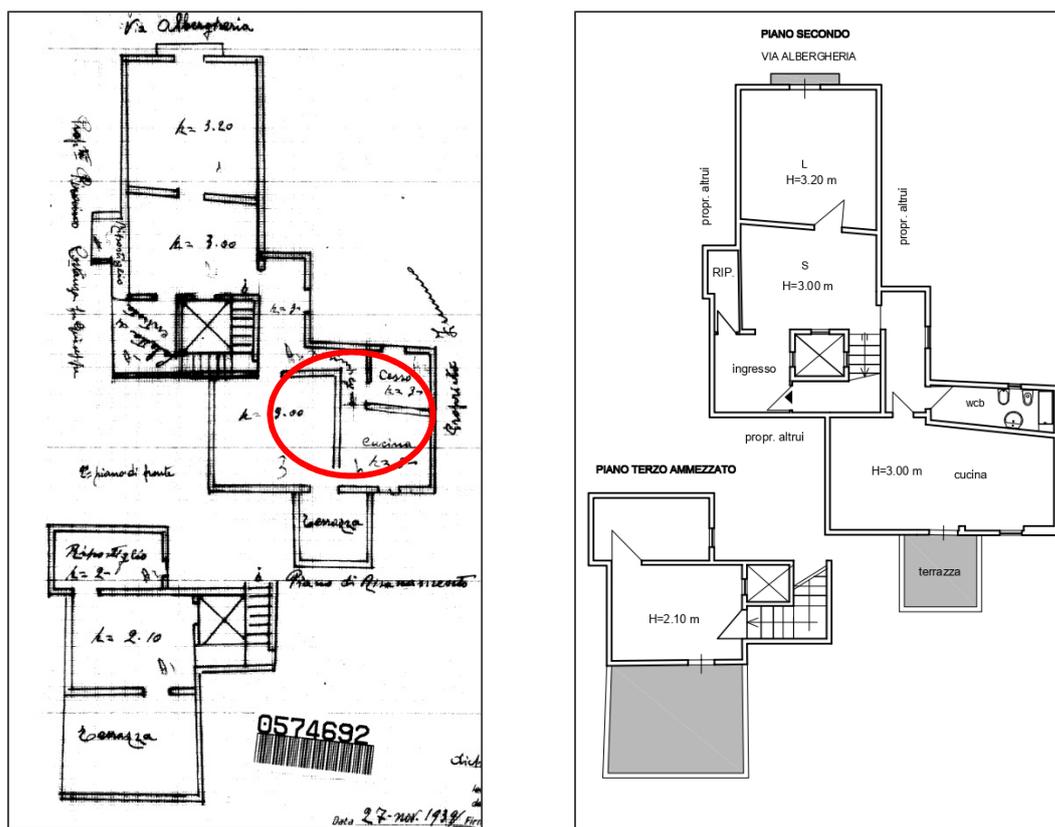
Raffronto tra planimetria catastale e planimetria reale
